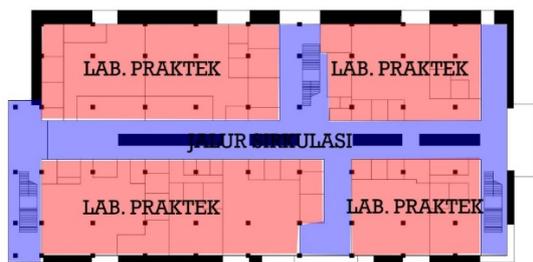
Ekspose kolom struktur Universitas Andalas (Sumber: Pribadi, 2020)
